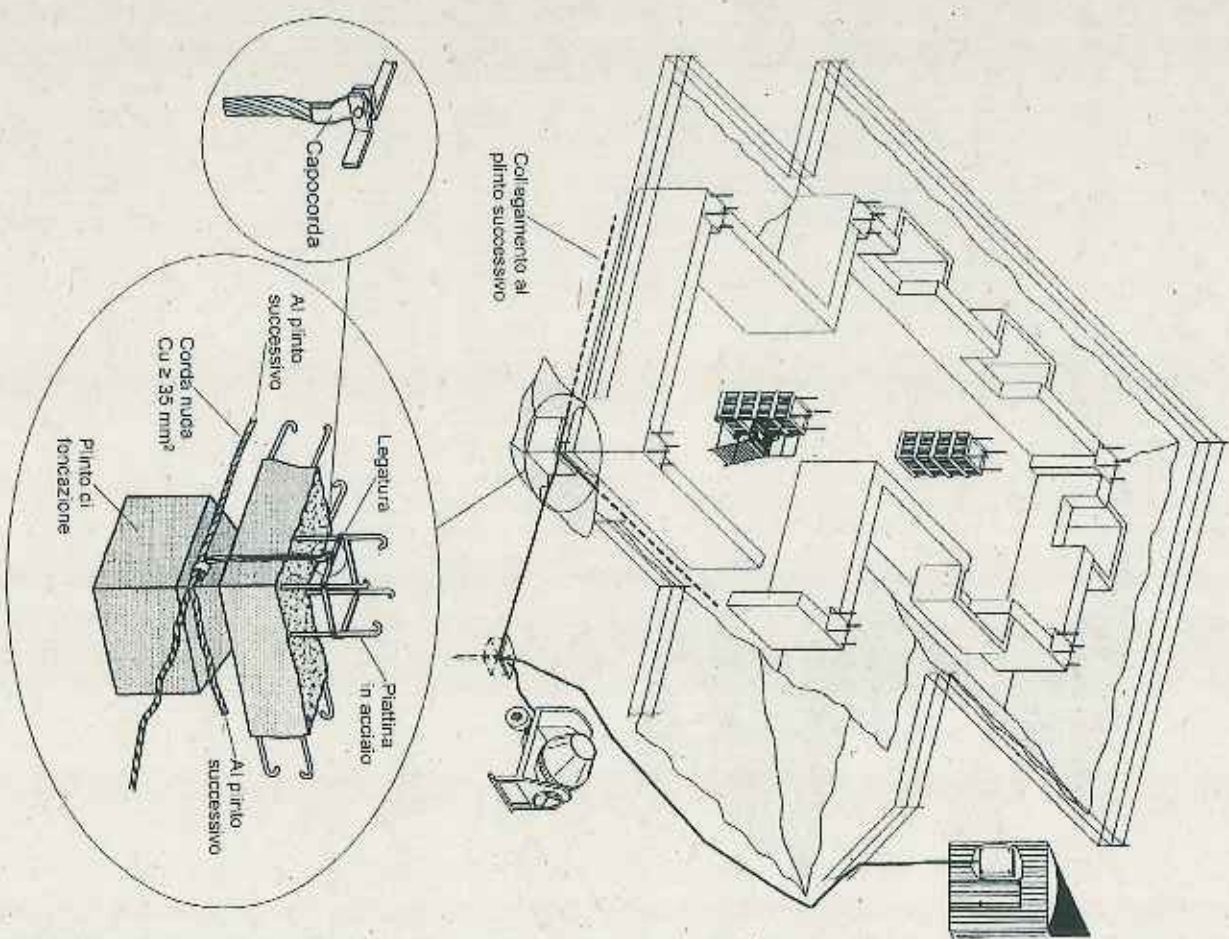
Esempio di impianto di terra di fondazione.
